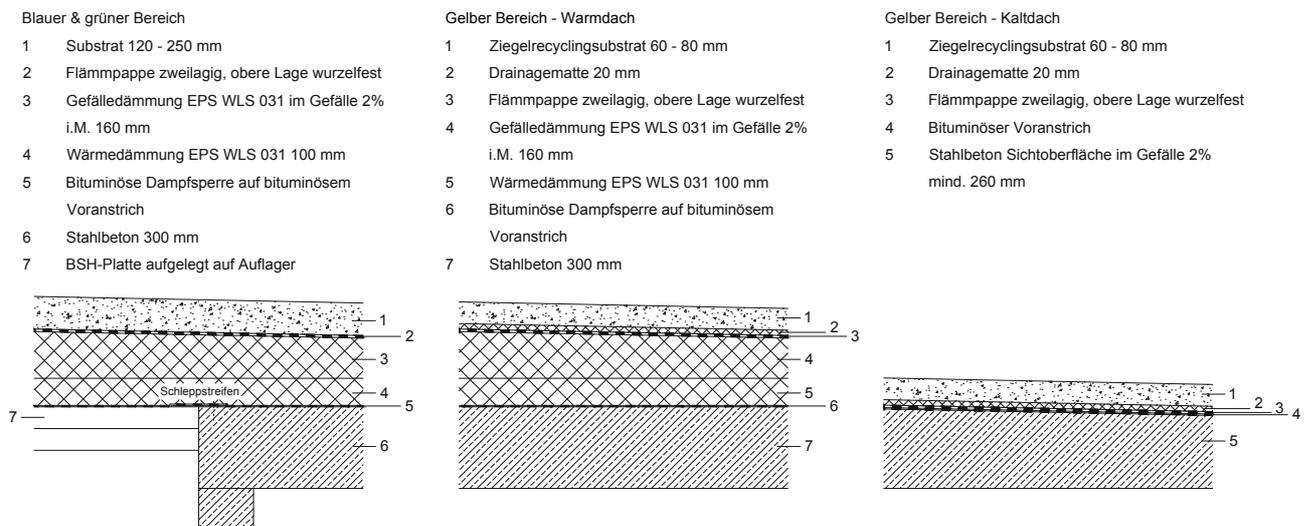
Dachbegrünung Kindergarten Ried – Aufbauten, eigene Darstellung © marte.marte architekten zt gmbh [107]
